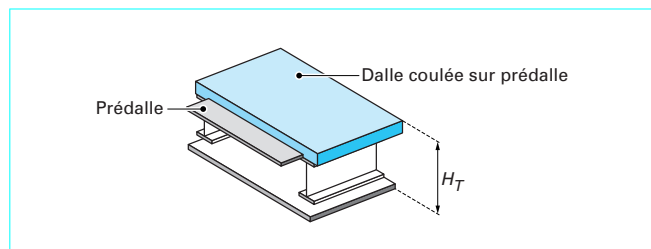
Plancher à poutrelles métalliques et dalle non participante
